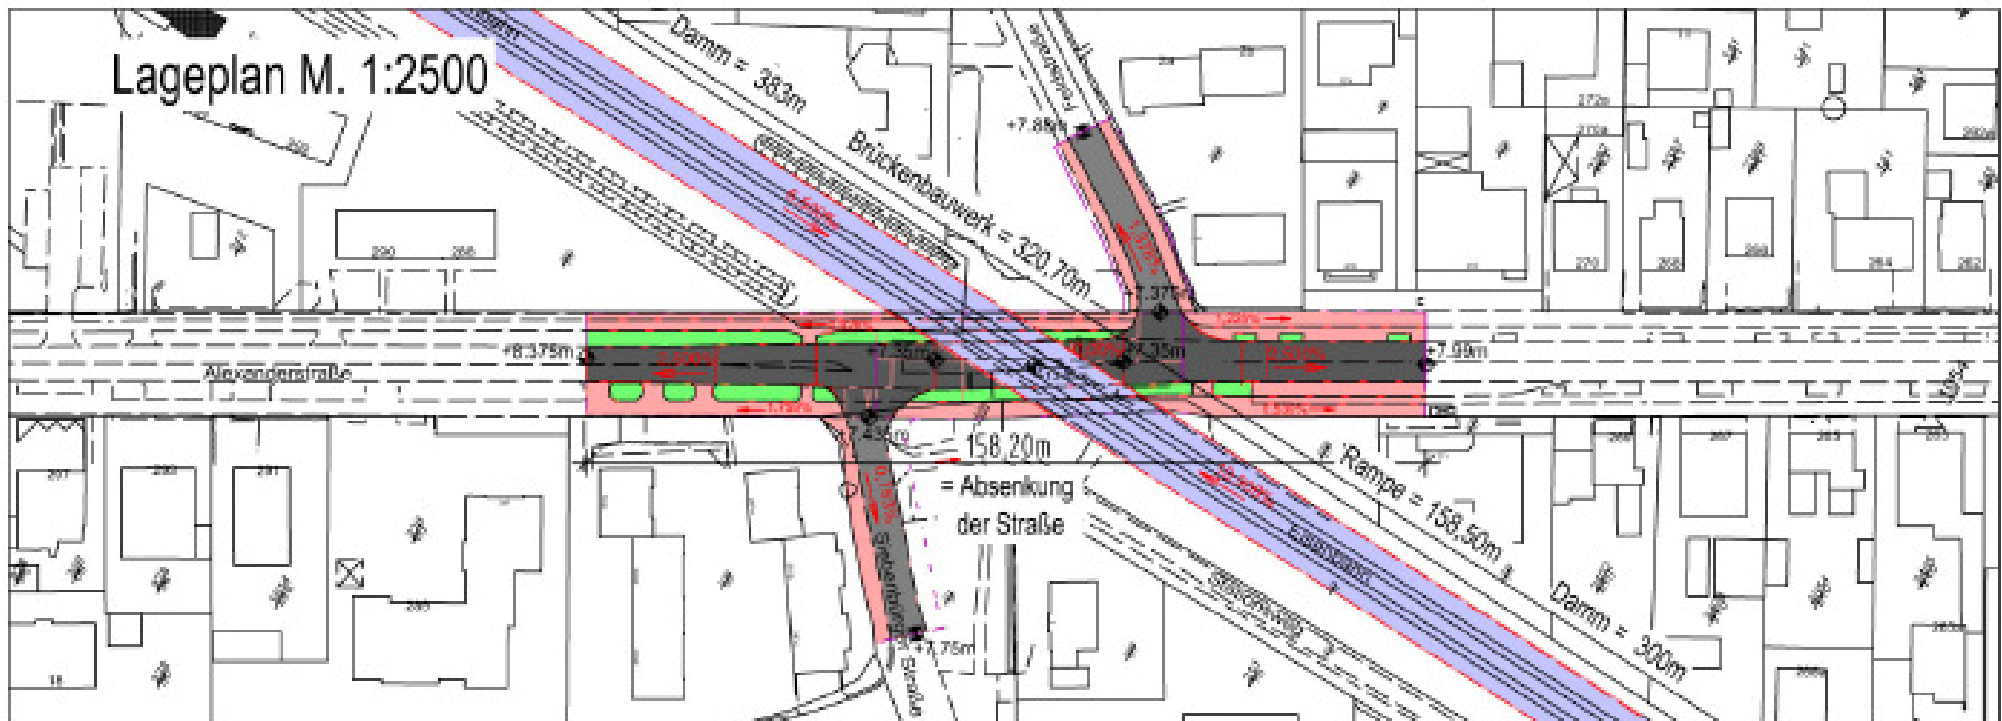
Bahnübergang Alexanderstraße mit der Einmündung Siebenbürger Straße
